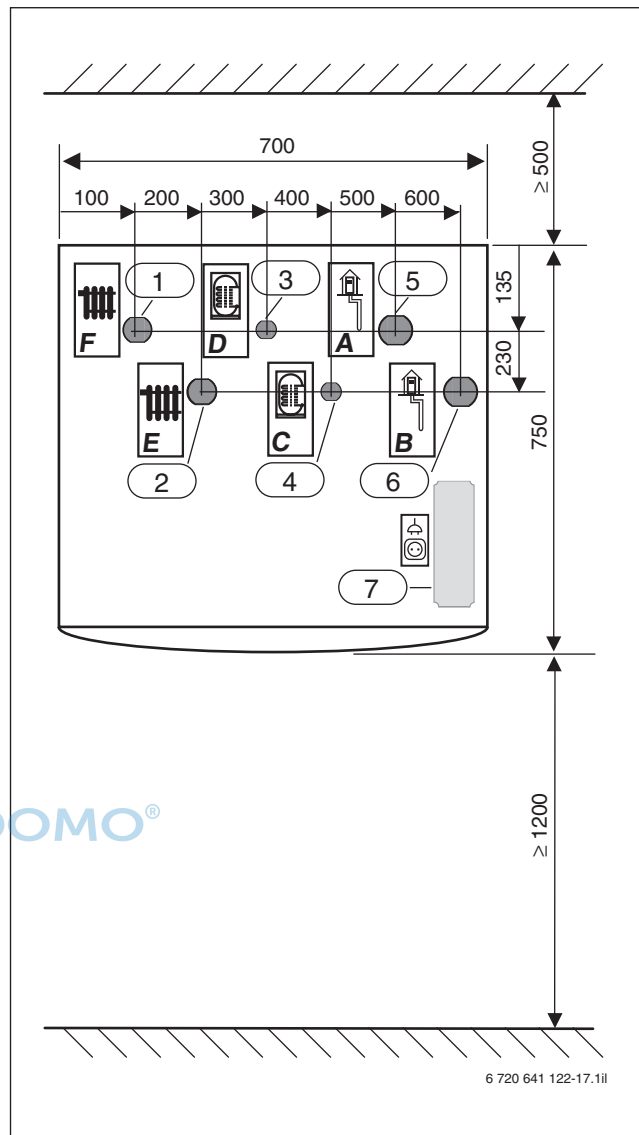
T 220-1 und T 330-2 (Maße in mm)
